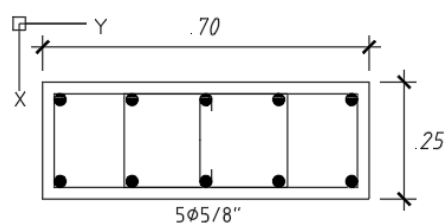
Detalle de refuerzo de refuerzo vertical de columna del tanque elevado.
